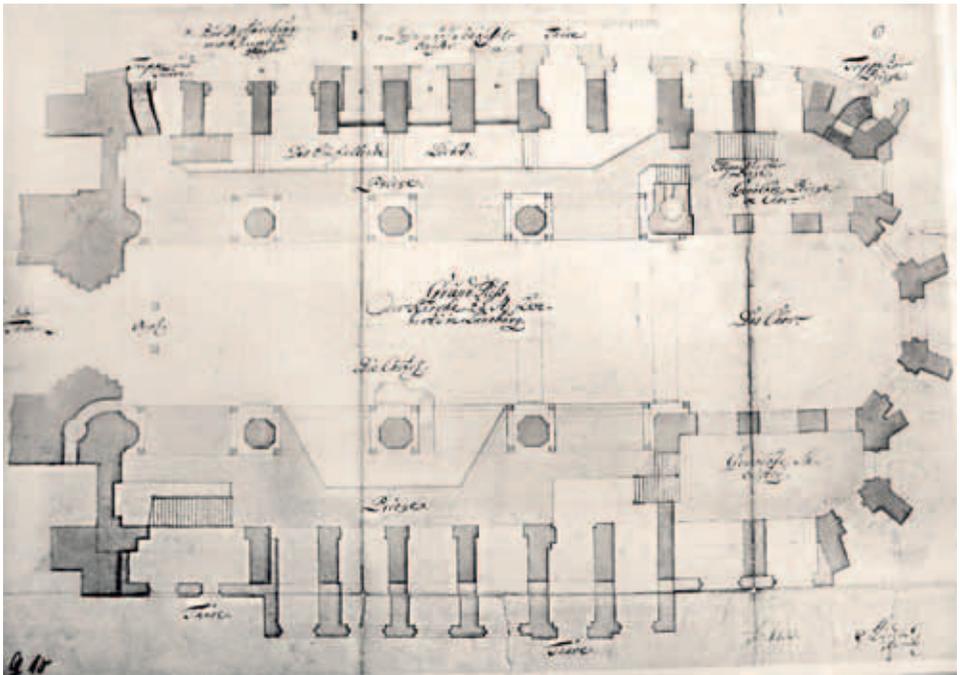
1733 Grundriss Lüders mit Vorschlägen zur Stabilisierung, u.a. Priechen und Verstärkung Säulen und Strebepfeiler_StadtALg P-16 C1-12 - G 10
